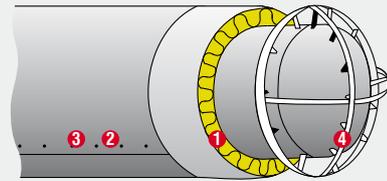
1. Маты ALFAROCK, 2. Защитный кожух, 3. Заклепки или шурупы, 4. Несущий обрuch
